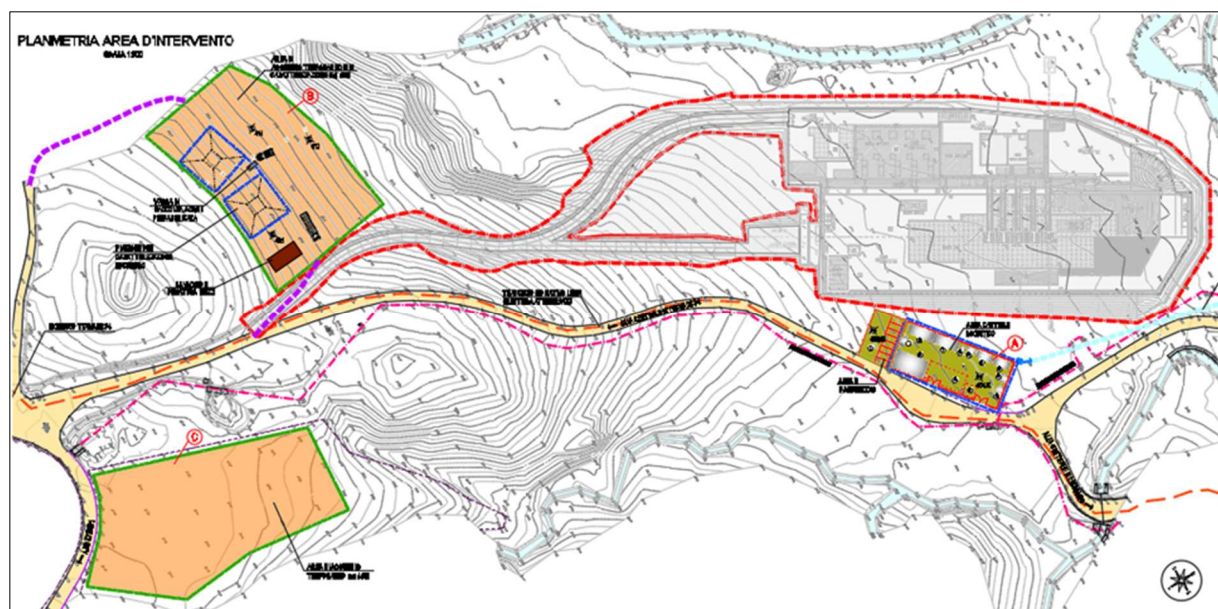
Stralcio della tavola GRE.EEC.D28.IT.G.13405.00.045. Planimetria e pianta cantiere civile.
